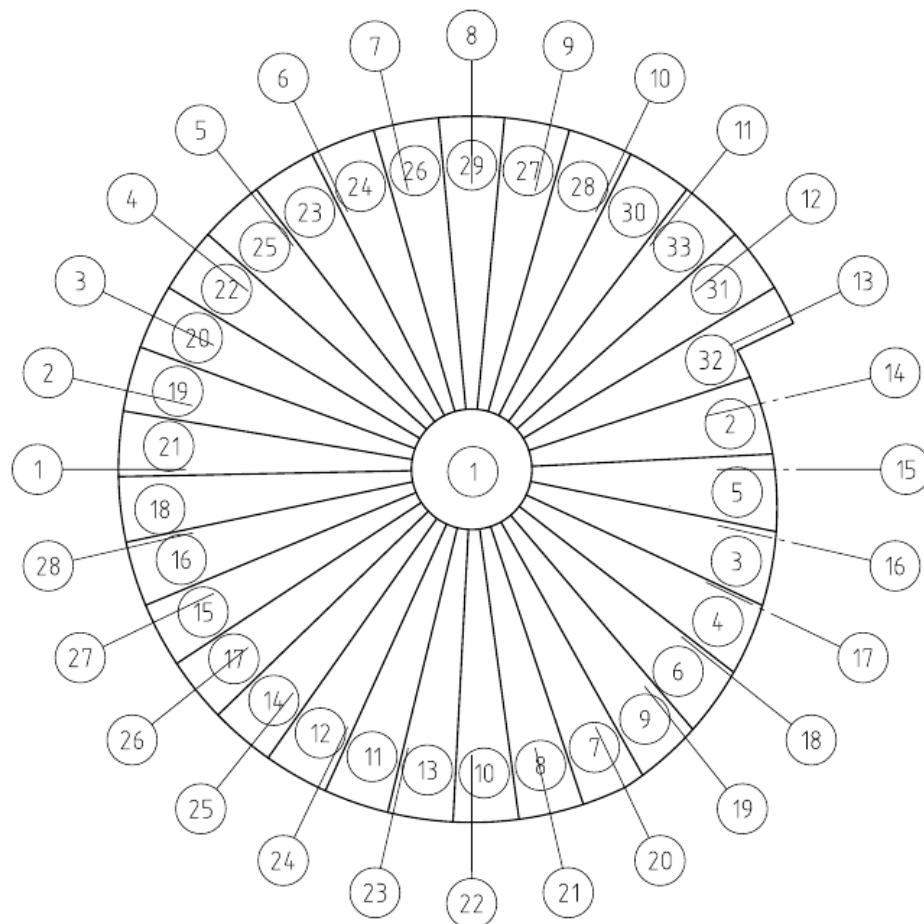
Схема разбиения фундаментной плиты на захватки
